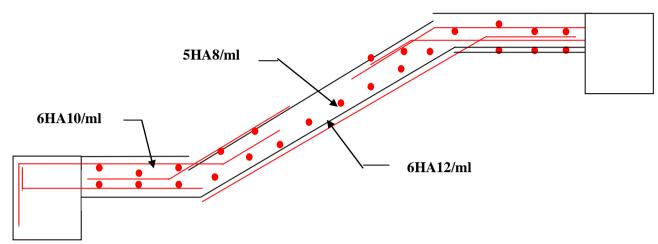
Schéma de ferraillage de la partie 1 de l'escalier.
